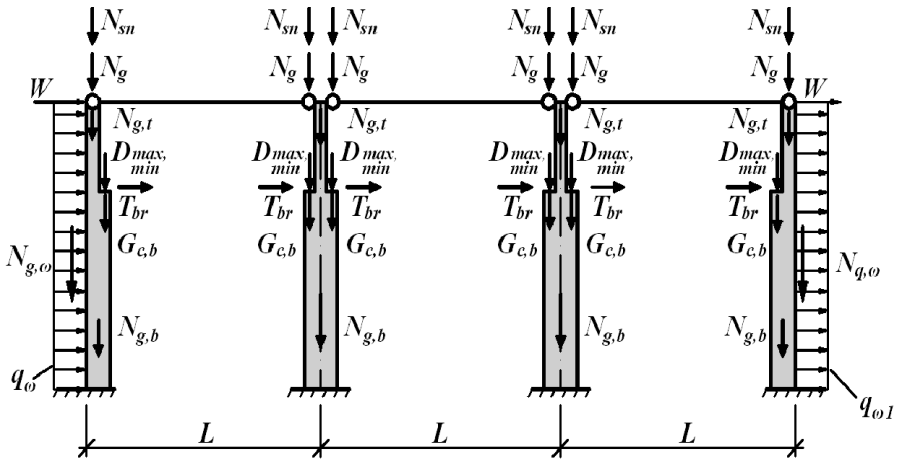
Розрахункова схема поперечної рами [11, рис. 4.7]
